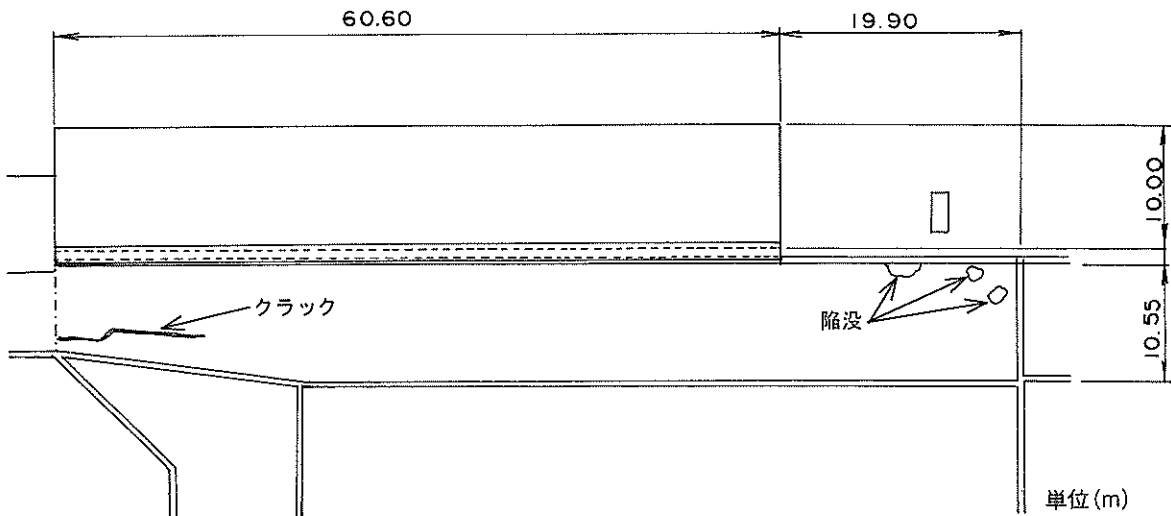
岸壁(-4.5m)(施設番号④)の平面図
